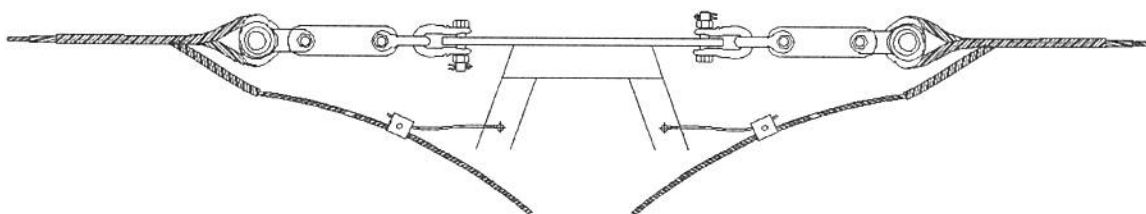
Referencia de conjunto de amarre bajante de OPGW para ser instalado en los 2 extremos de la torre.
